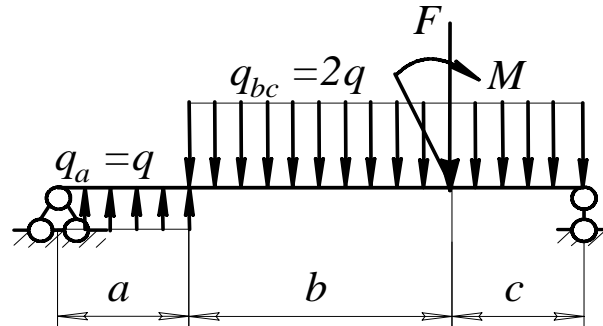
Construction et schéma du chargement de la poutre examinée
